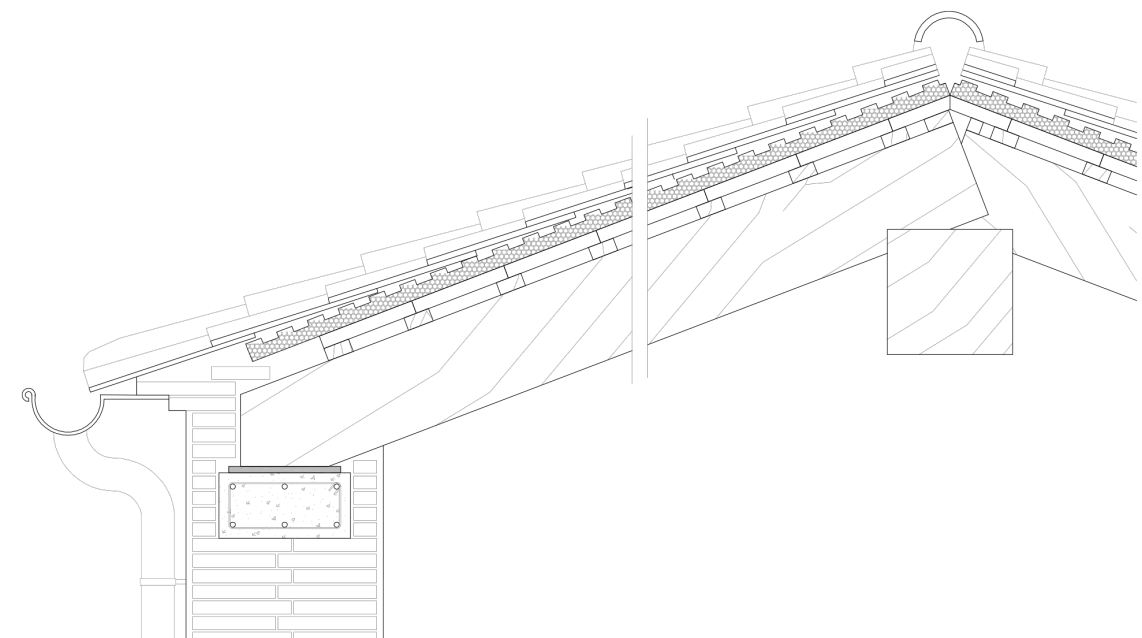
Sección de la solución constructiva de la cubierta de todo el inmueble. Autor Propio. 2015.
